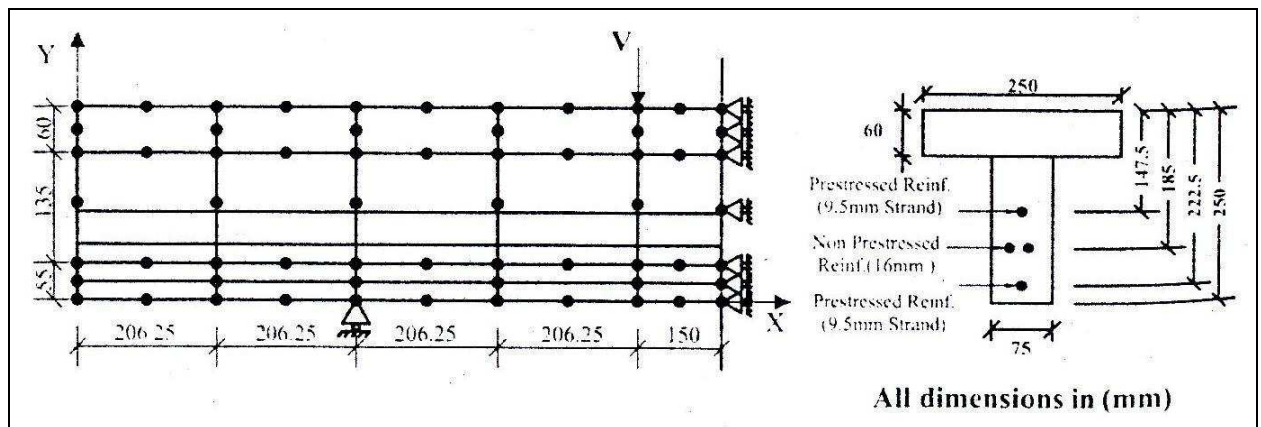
Détail de renforcement et la géométrie des poutres [30]
